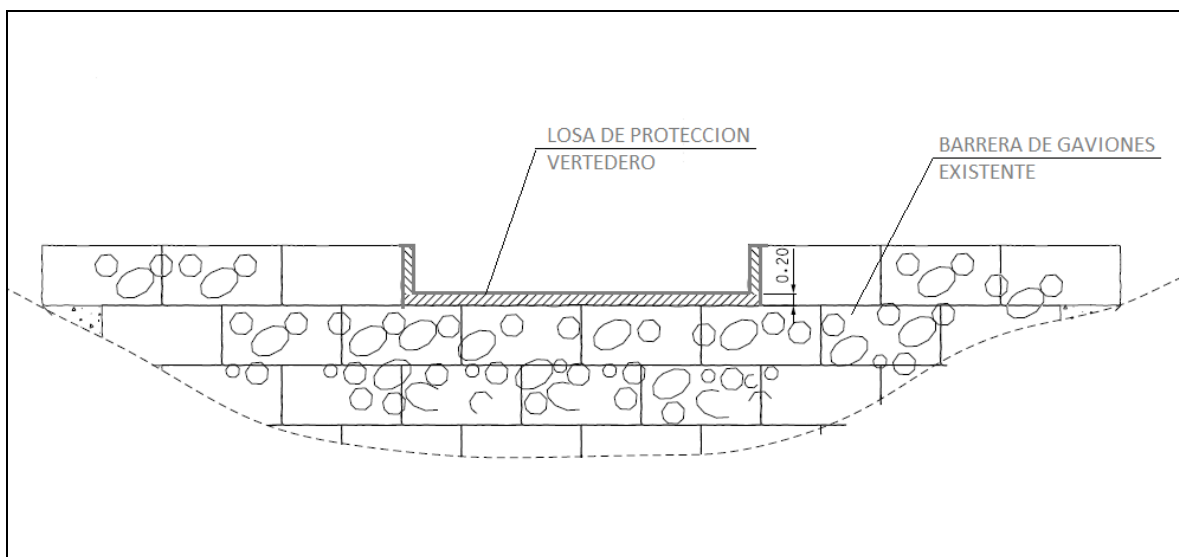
Losa de protección de vertederos de barreras de gaviones
